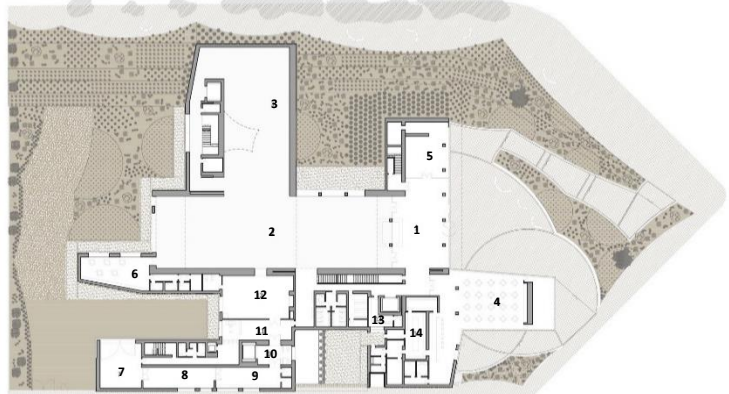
Planta baja arquitectónica del conjunto MUSEO IBERO. Santibañez, D. (12 de septiembre de 2020). ArchDaily.
